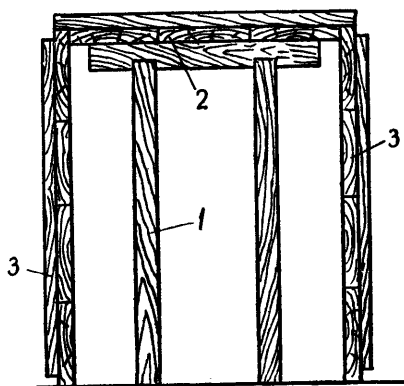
Приспособление для сборки коробов опалубки колонн, прогонов и балок:
